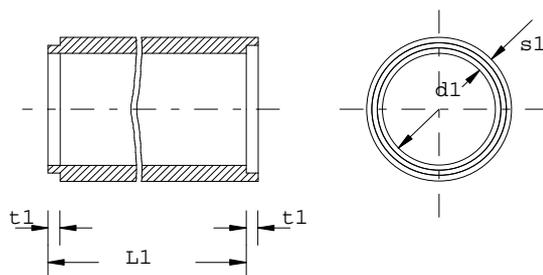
tubi in calcestruzzo di sezione circolare con giunto a risega senza piede
